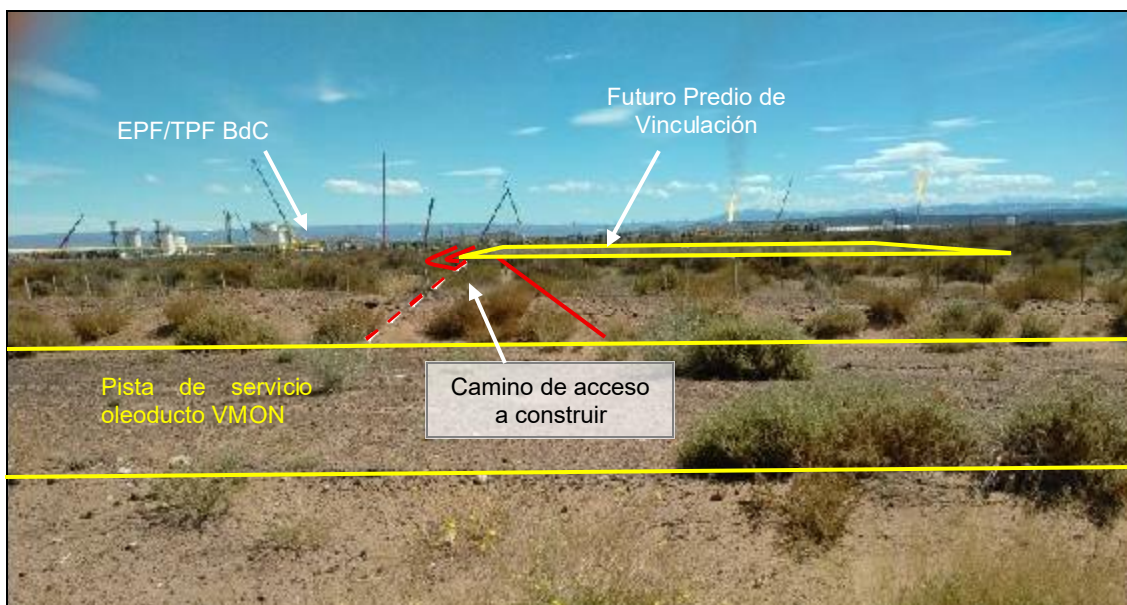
Vista, hacia el Oeste, del camino a construir para acceder al futuro Predio de Vinculación desde la pista de servicio del oleoducto VMON. Coordenadas: x: 5825968; y: 2488531.
